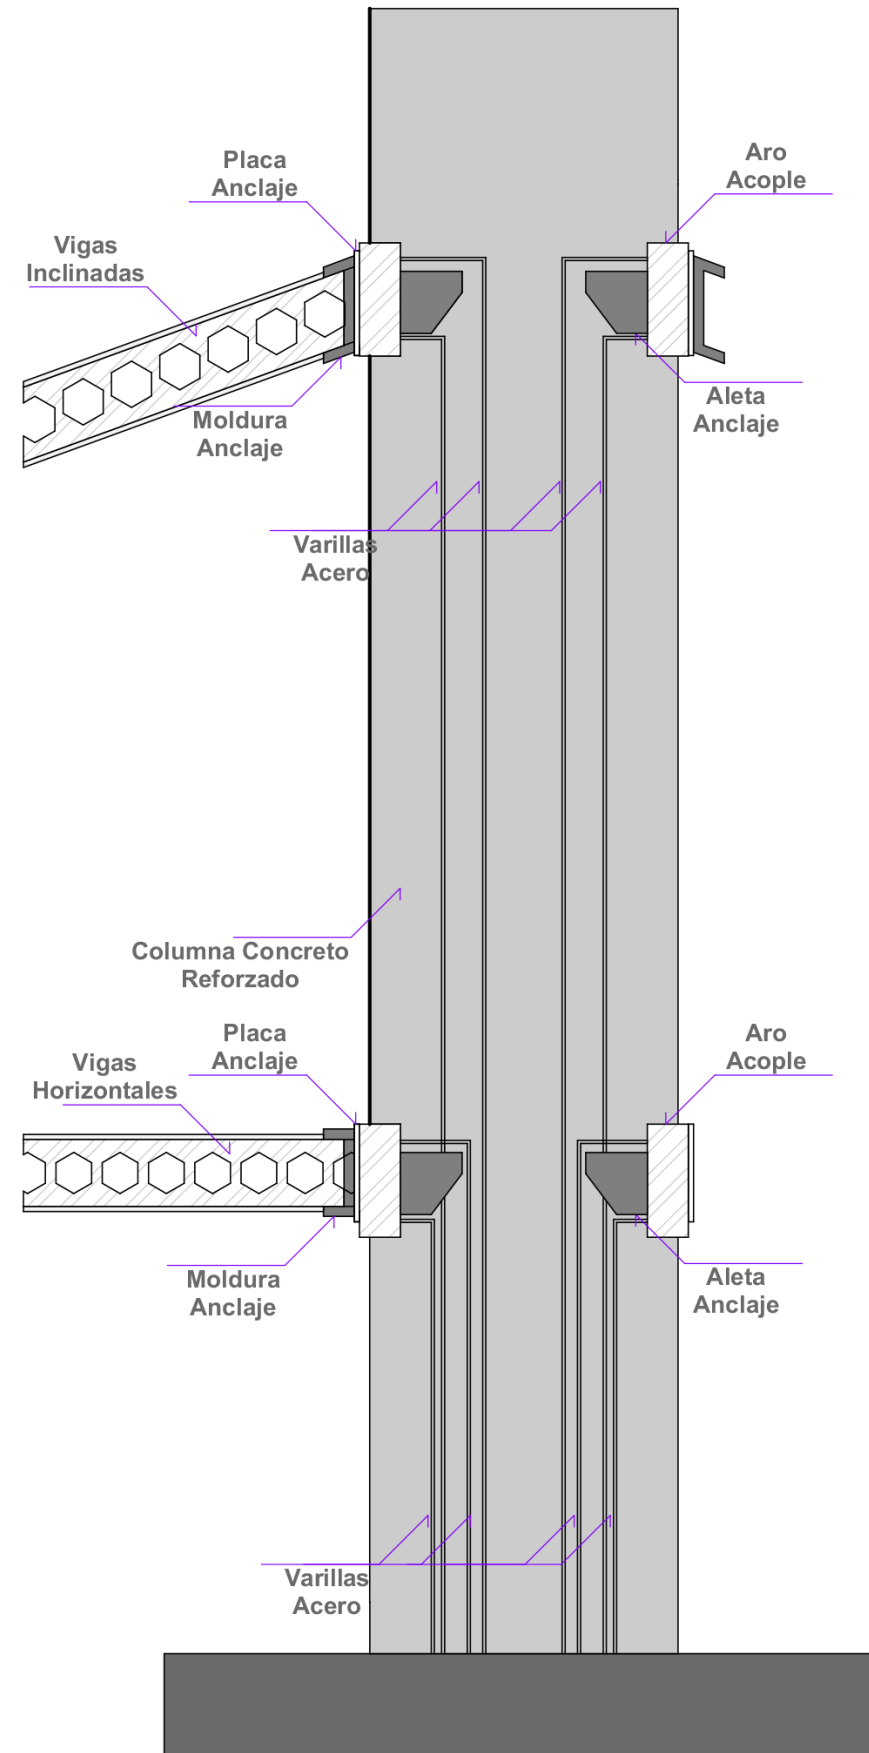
, Detalle Constructivo Columnas Principales, Propiedad Personal, Tomado 2023
